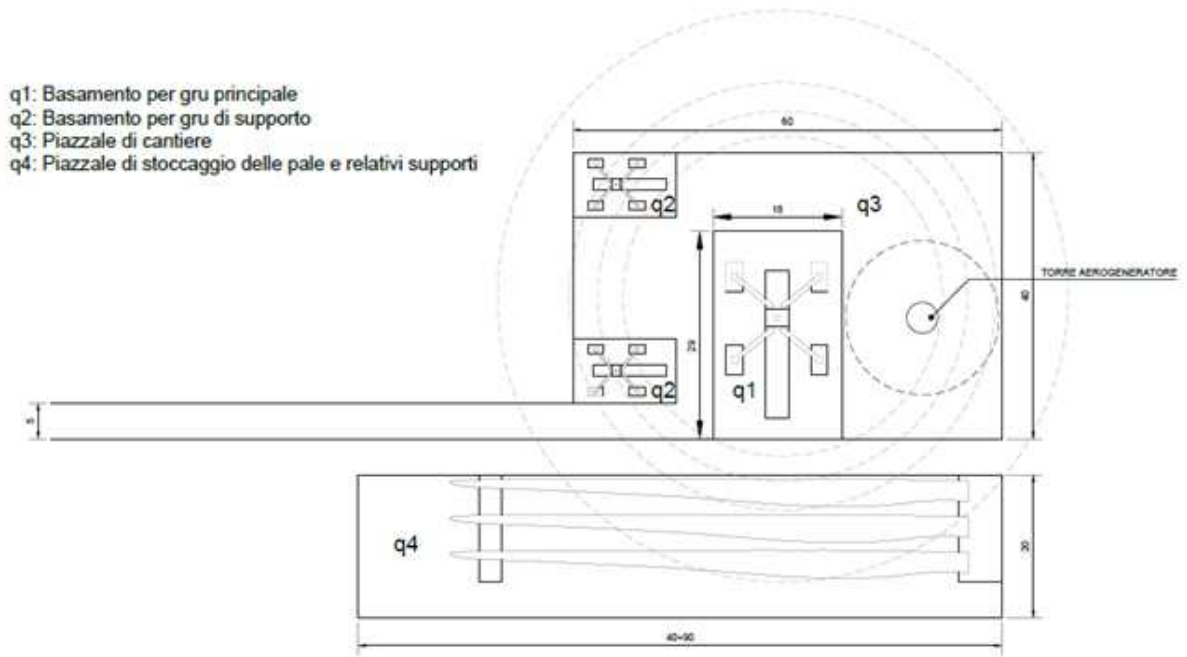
Layout tipico di cantiere per un aerogeneratore con misure in metri.
